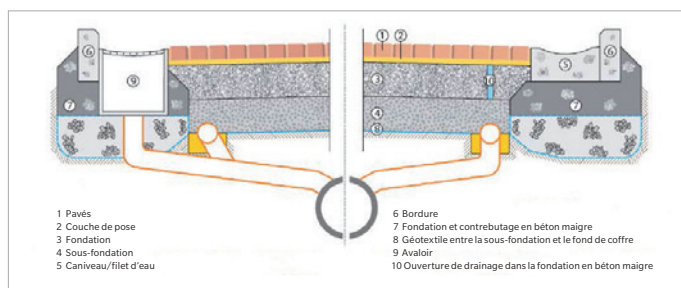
coupe type d'un drainage à travers une fondation en béton maigre (n°10) vers la sous-fondation (CRR, 2009)
